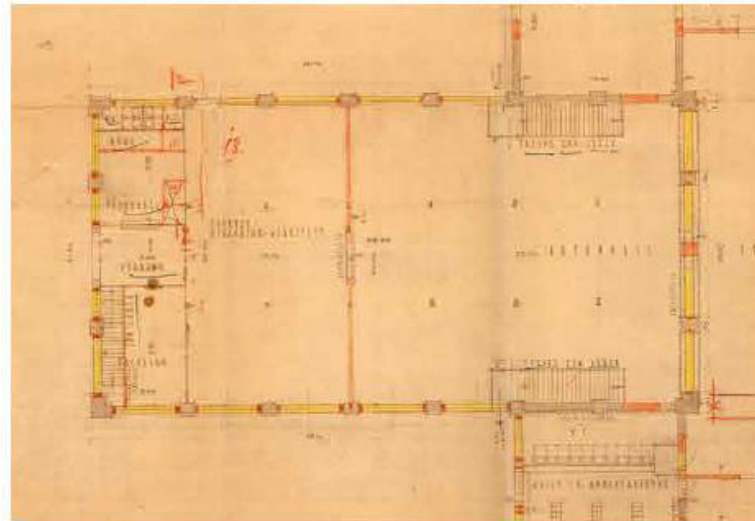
Plan für den Umbau durch Adler-Werke als Fahrrad-Werkstatt (links)/Automobil-Werkstatt (rechts) (1927). Architekt: Walter Hämer. Grundriss EG. Öffnung der Außenwände, Einbau Zwischenwand, Büro, Treppe (Bd. 05/016)
